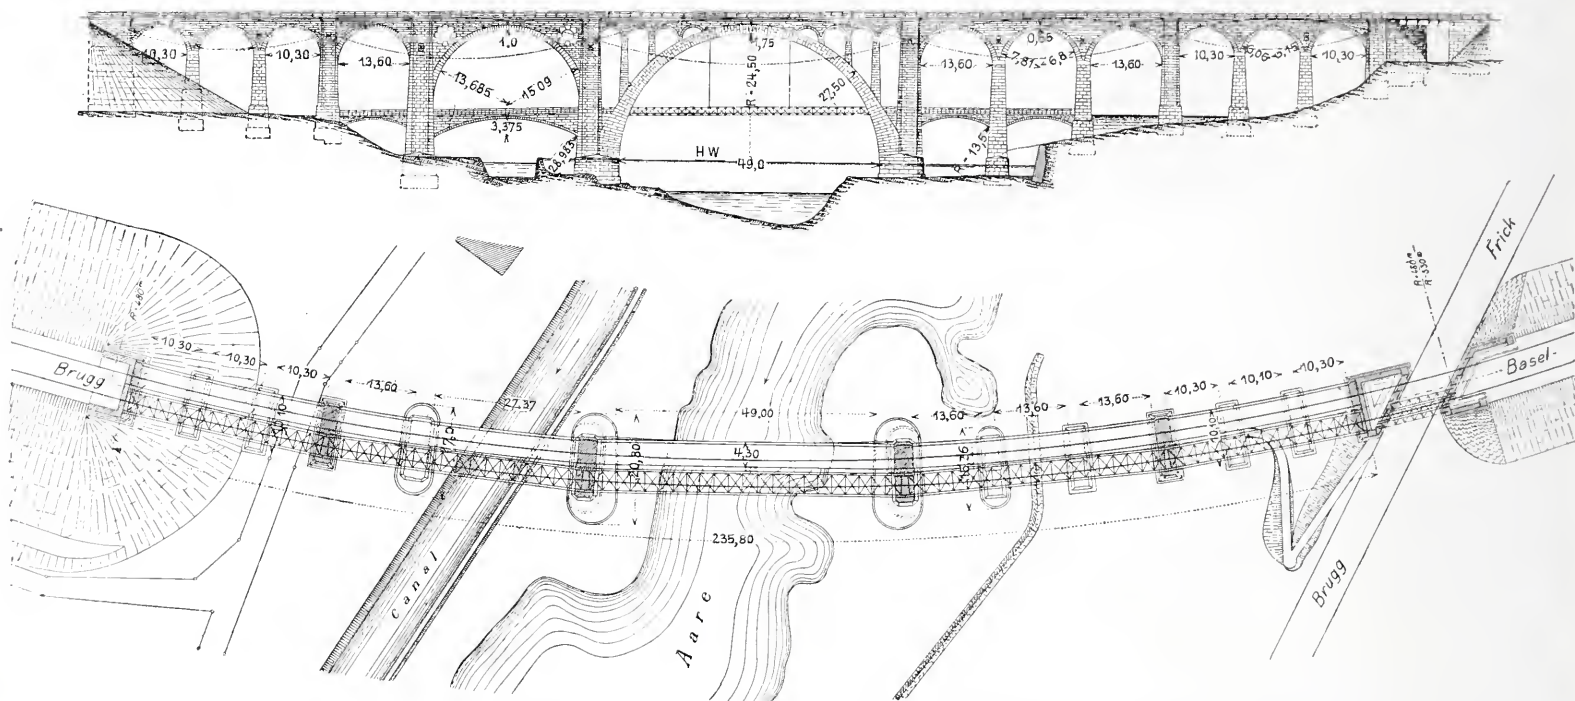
Entwurf der Generaldirektion der S. B. B. zu einer steinernen Brücke mit Halbkreisgewölbe für die Mittelöffnung. Ansicht und Grundriss. — Masstab 1 : 1500.
